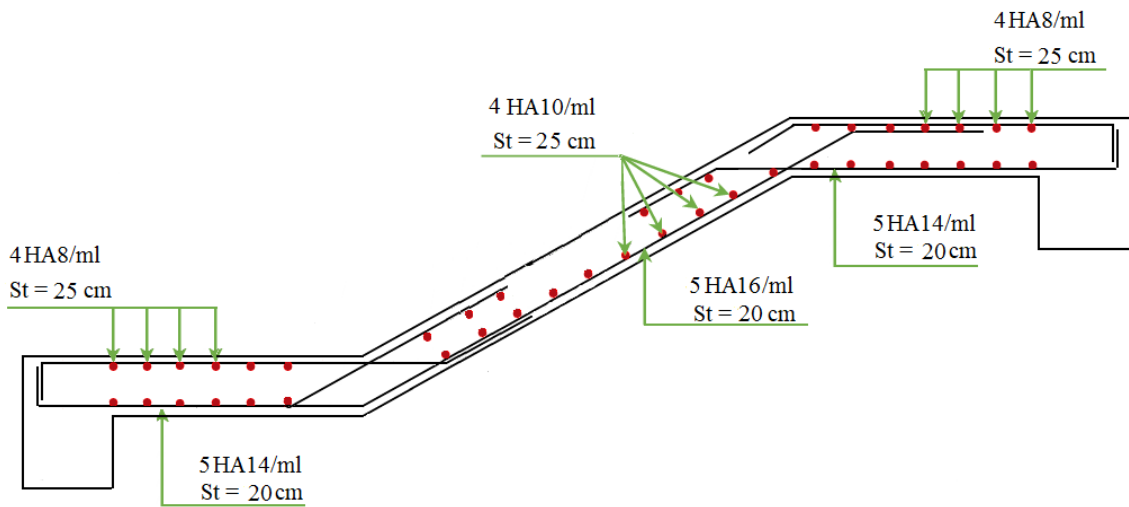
Schéma de ferrailage escalier type 2 RDC
